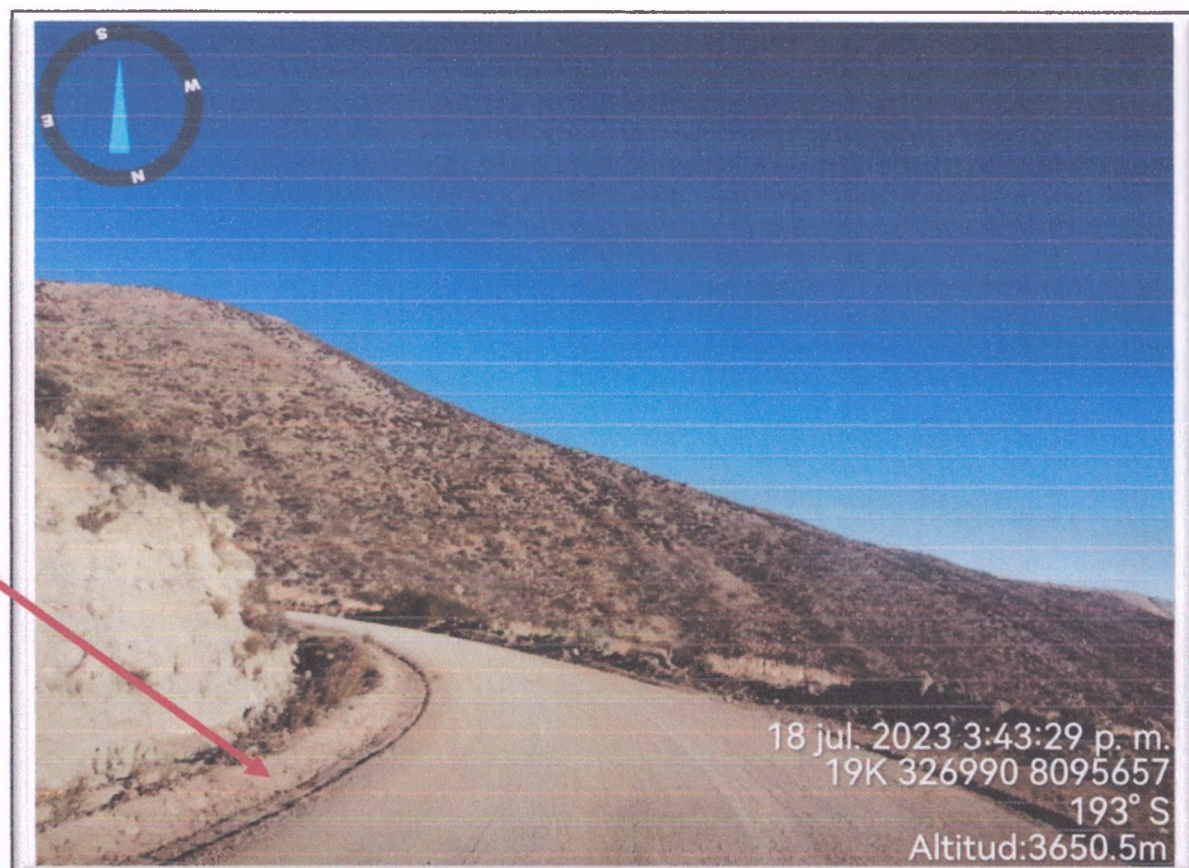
Vista de Cuneta saturada de piedras, arena y tierra en MI.
